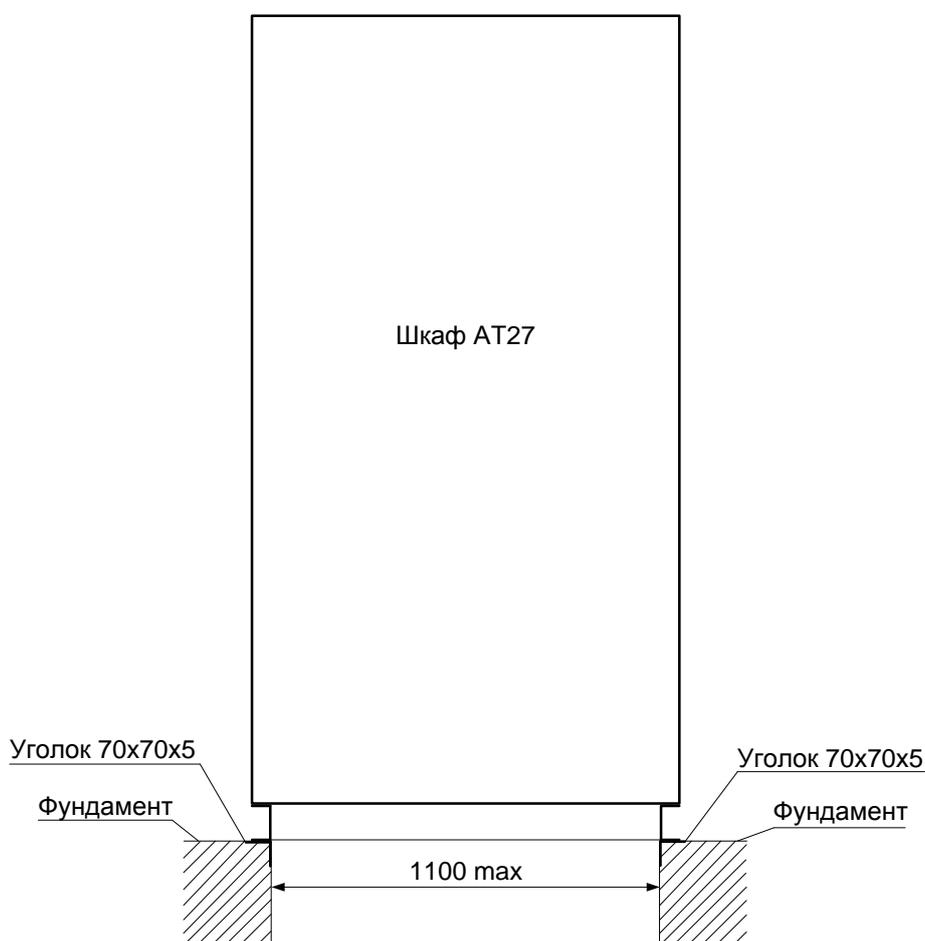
Установка шкафов АТ27 (кроме ШУ) на фундамент
